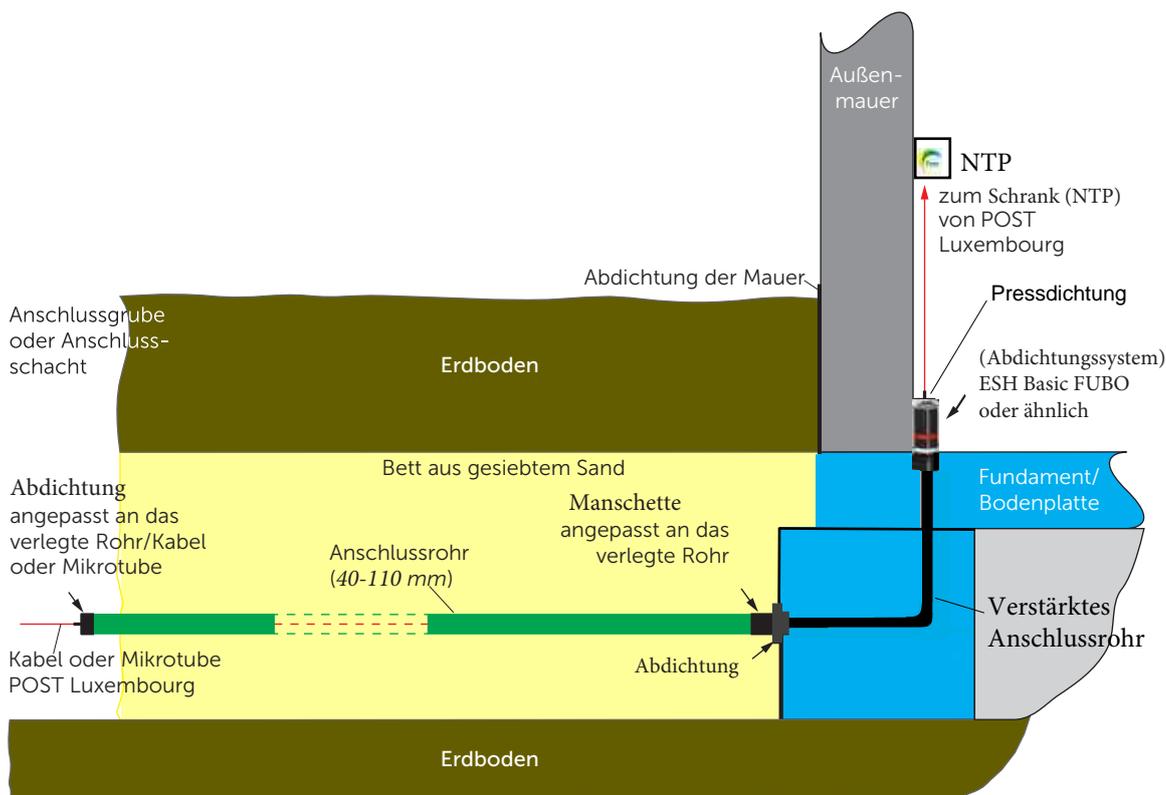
Einführung der Kabel/Microtube ins Gebäude durch die Bodenplatte
